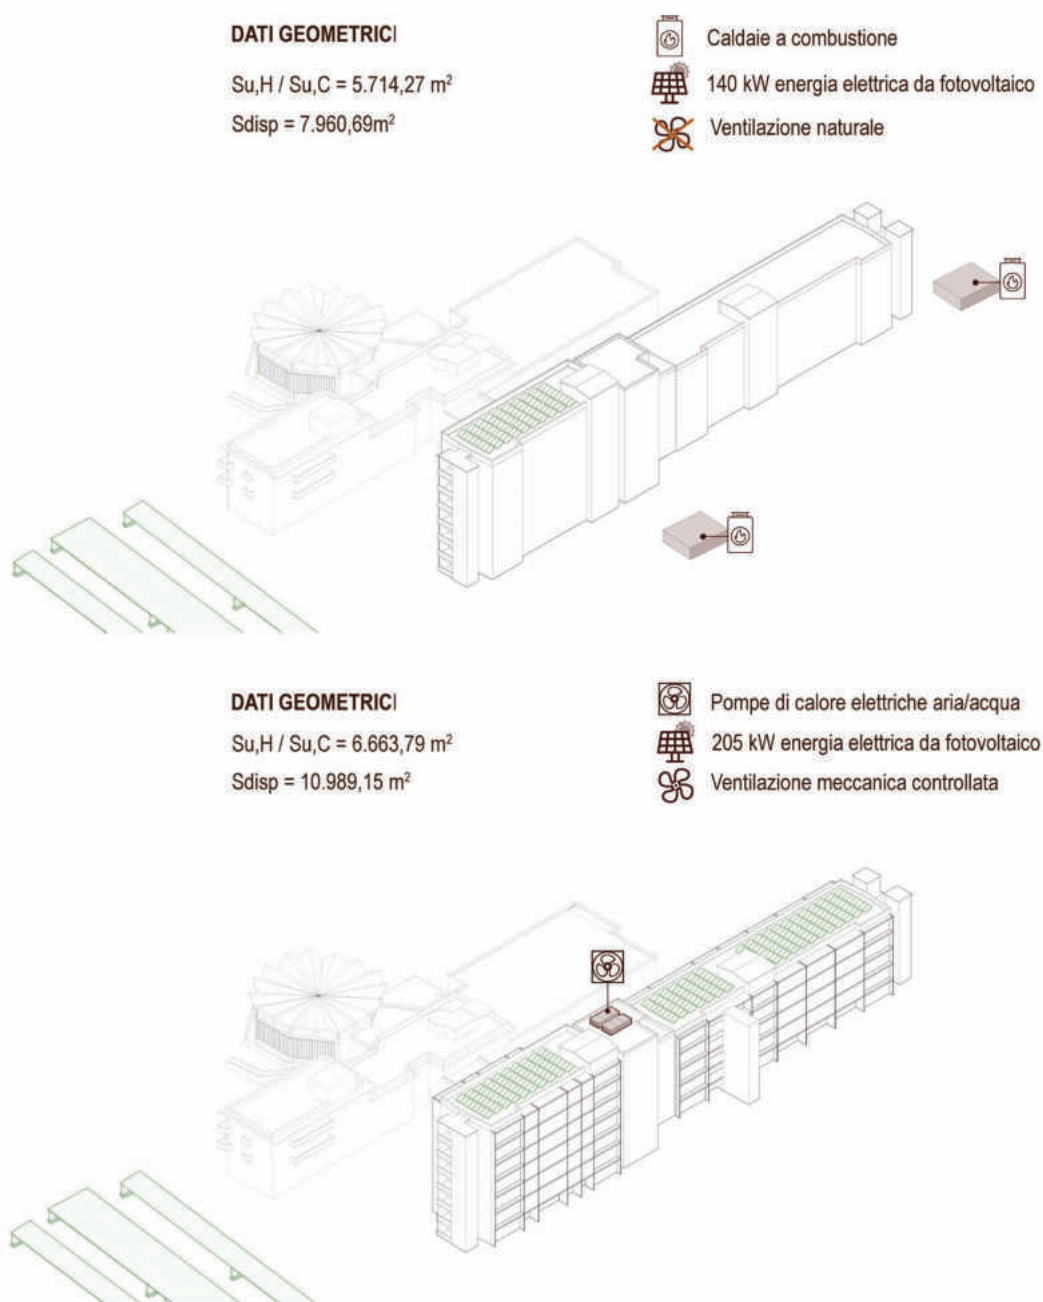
Confronto tra stato di fatto e di progetto della configurazione impiantistica.
